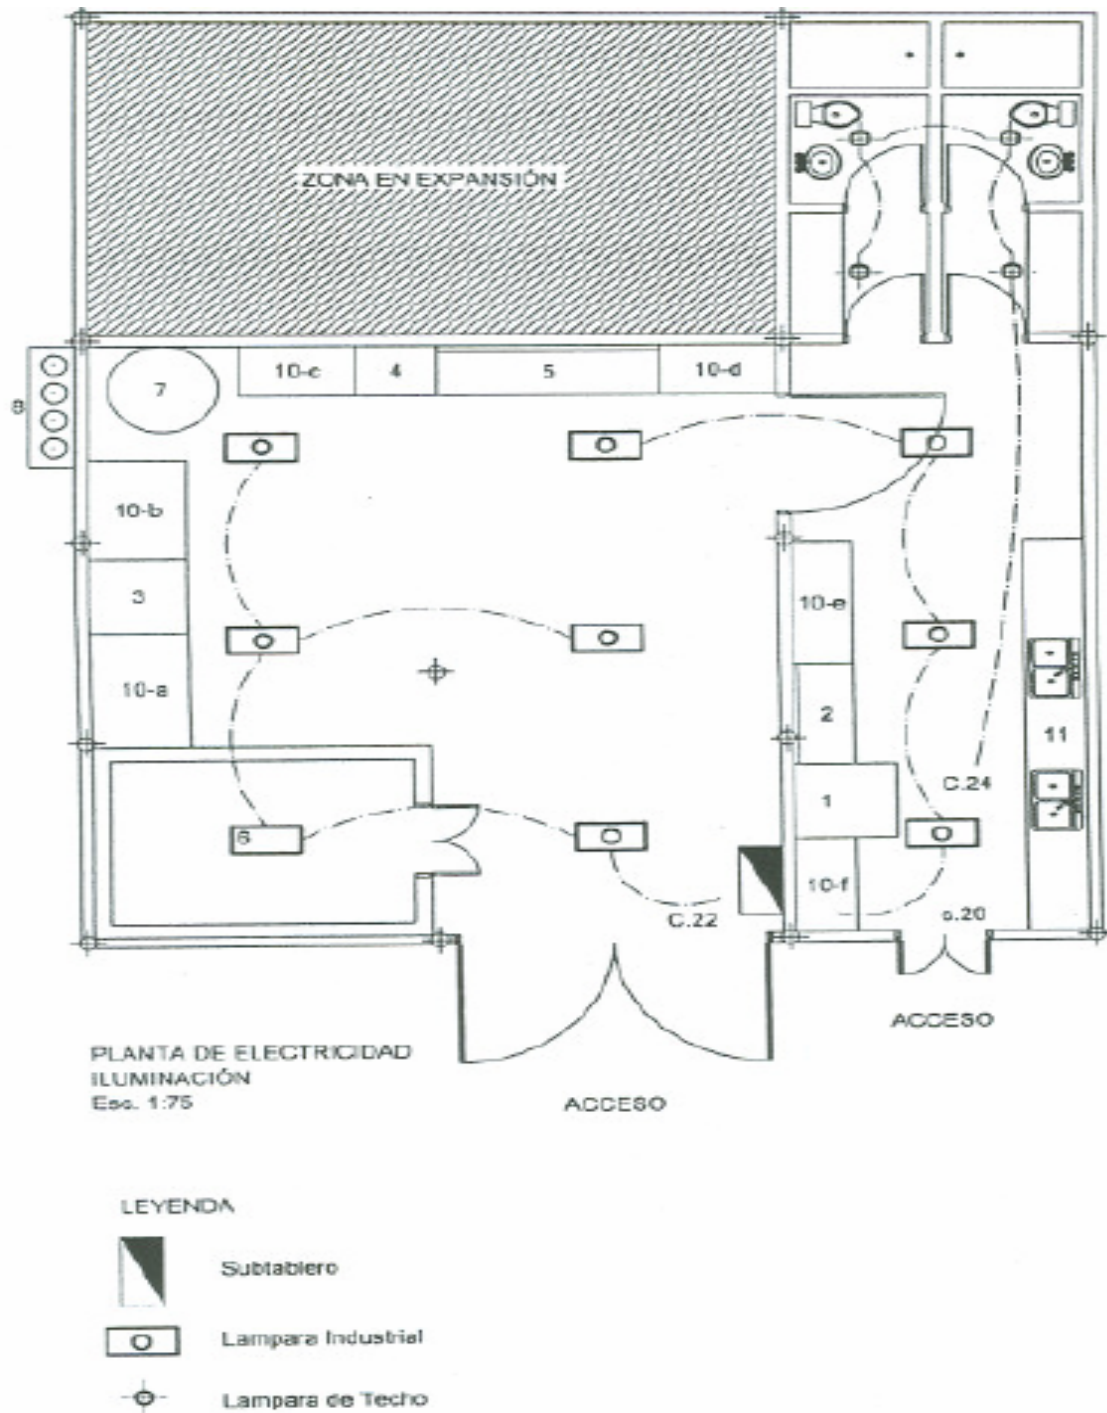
Planos de instalaciones eléctricas (iluminación) en la planta de producción Frutícola Altos de Sucre.
